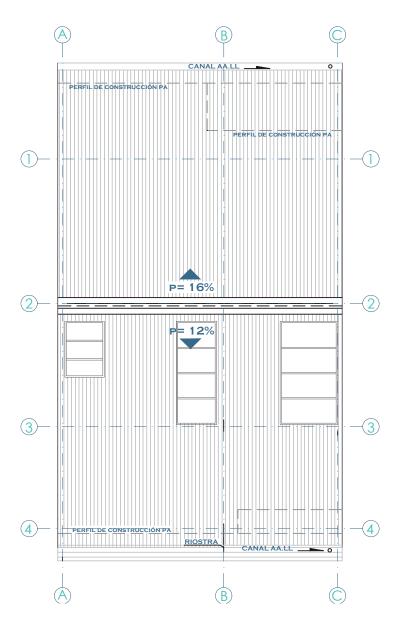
Planta cubierta propuesta Nota: Elaborado por el autor
